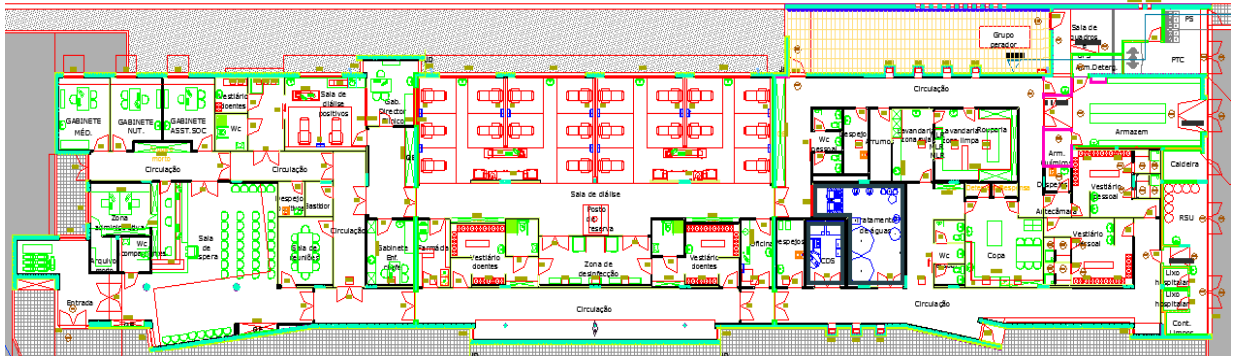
Planta do rés-do-chão do edifício (Fonte: Projeto de Arquitetura)
